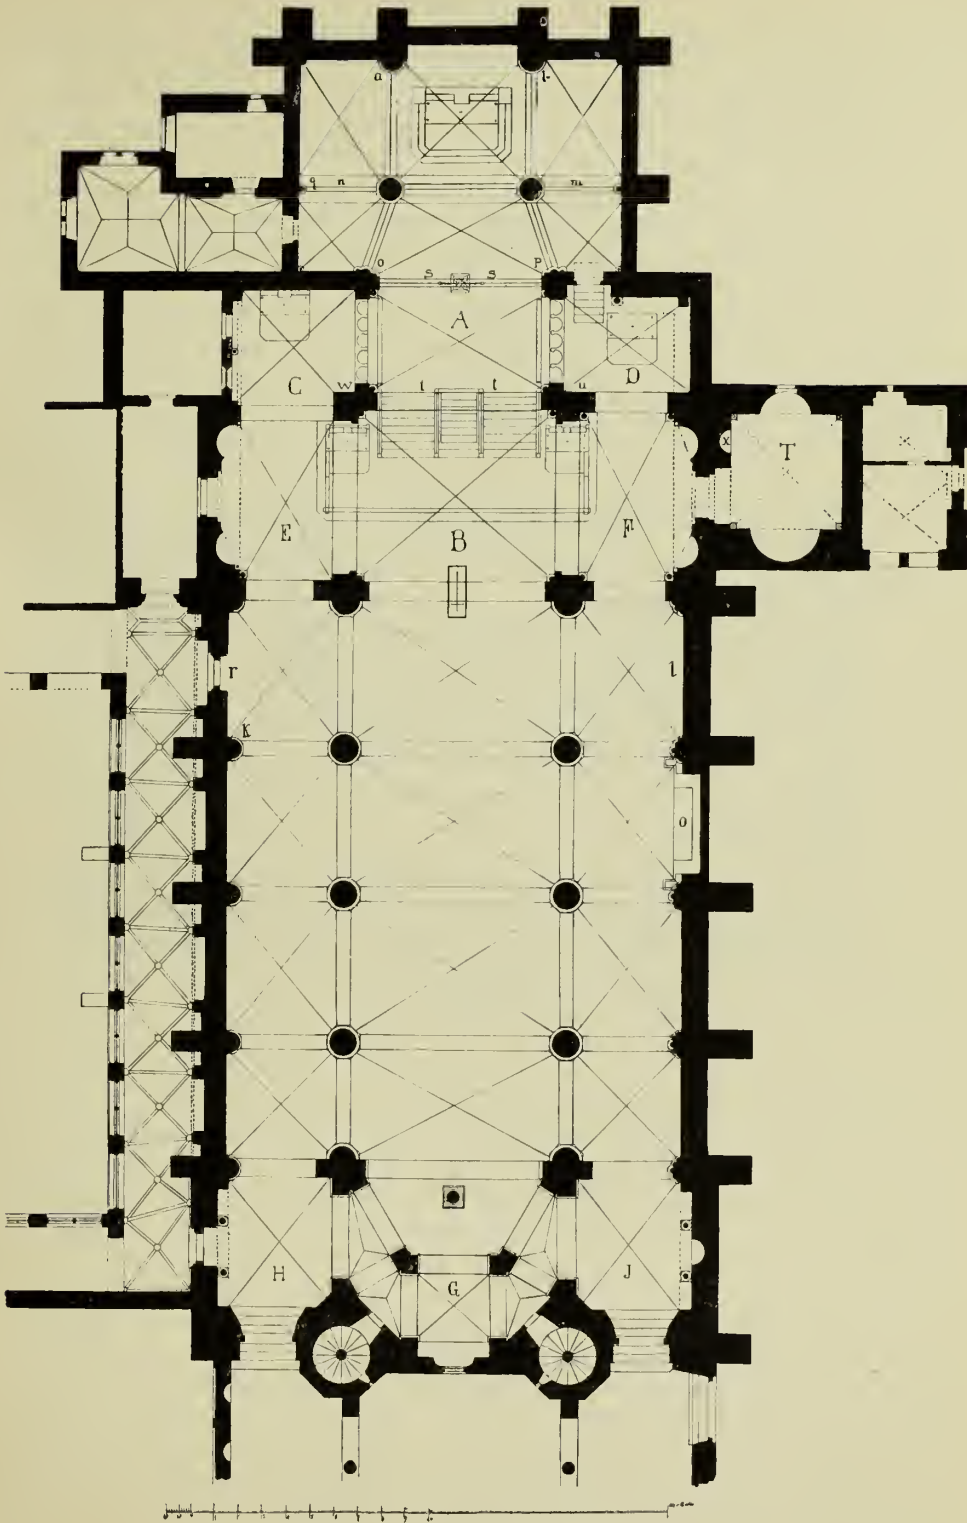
Essen. Grundriss der Münsterkirche.
